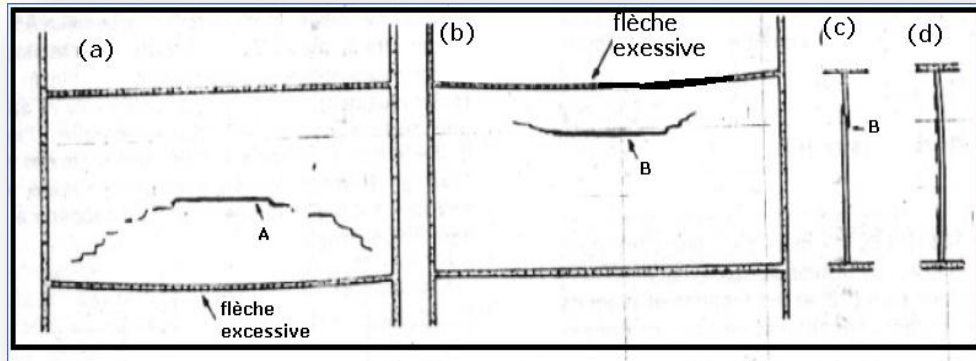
effet de la flexion des dalles de planchers sur une cloison plâtrière en brique creuses.
